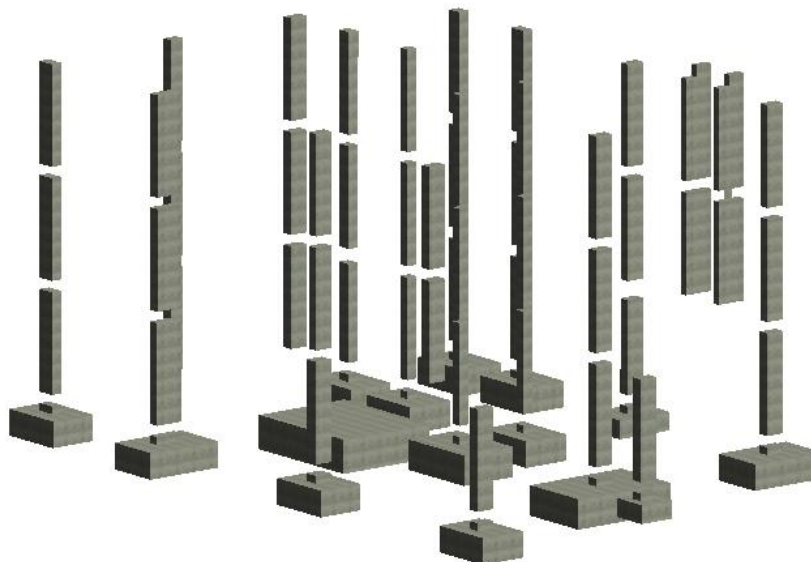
Elementos de Fundações e Pilares do Modelo Virtual.
